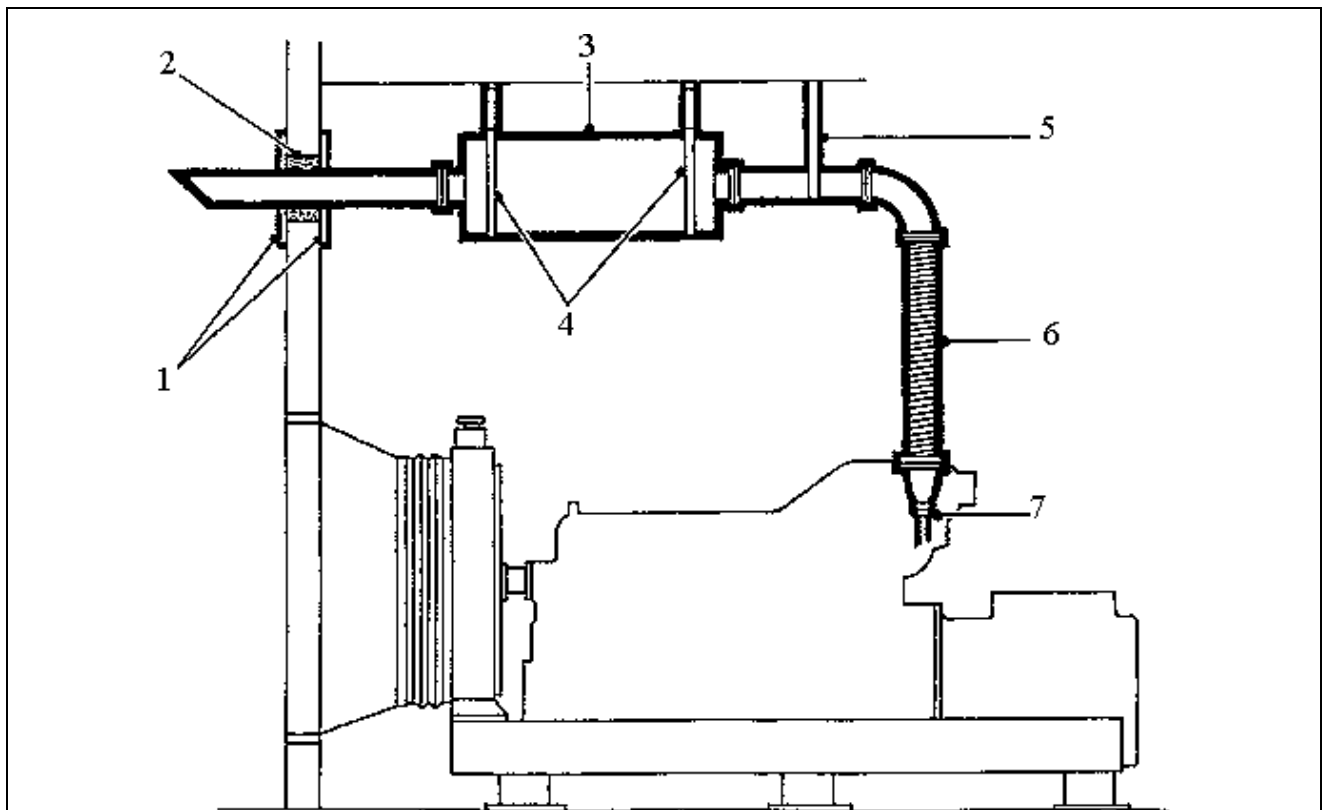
1-уплотнительные пластины; 2-изолирующая набивка; 3-глушитель первой ступени; 4-крепежные хомуты с зазорами, допускающими тепловое расширение; 5-крепежный кронштейн трубы; 6-гибкая труба; 7-слив конденсата. 805.2
